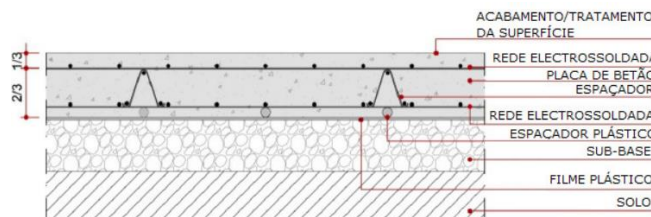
Pavimento de betão reforçado o com dupla malha eletrossoldada ⁷
